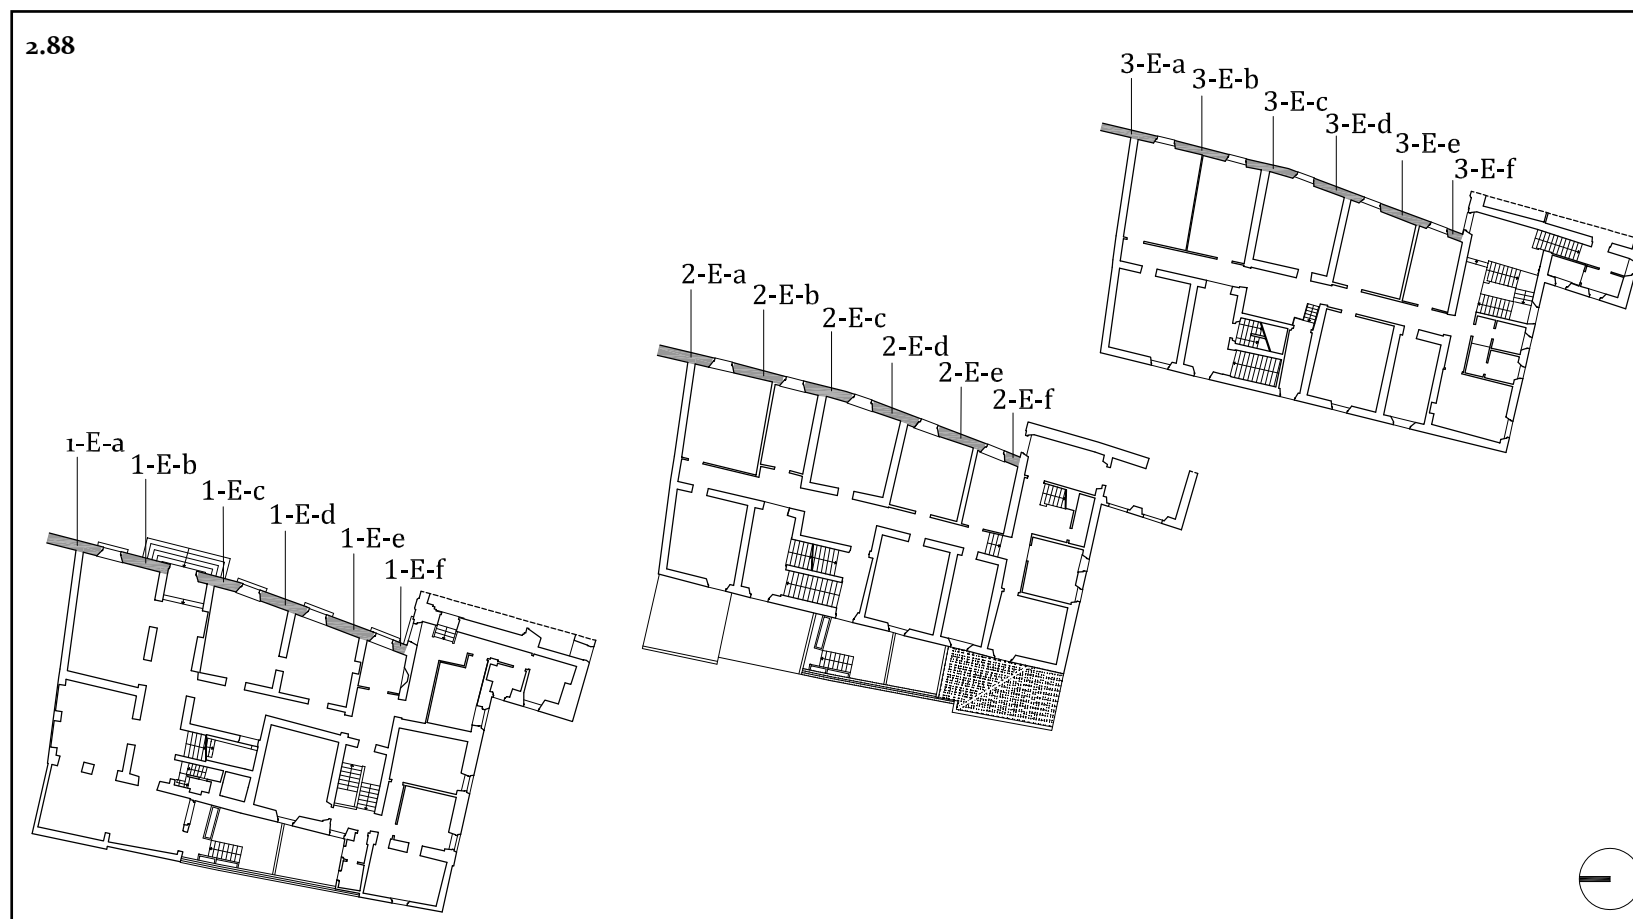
Pianta del piano terra, primo e secondo con indicazione dei maschi murari che compongono la facciata.
